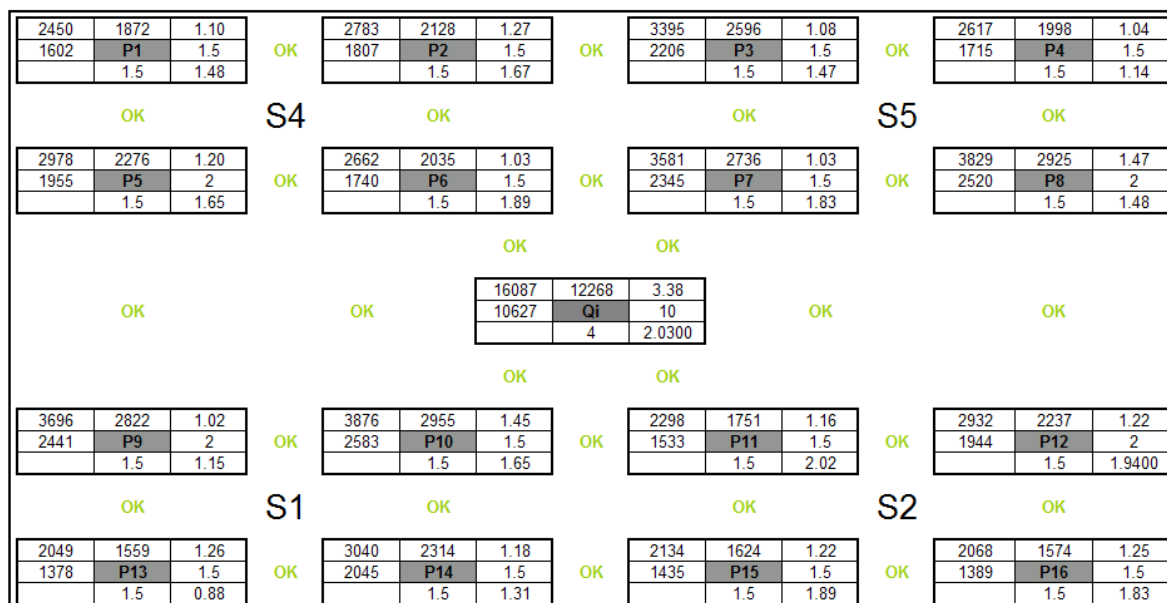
Planta esquemática e resultados (reações e assentamentos) das sapatas de fundação (molas).
